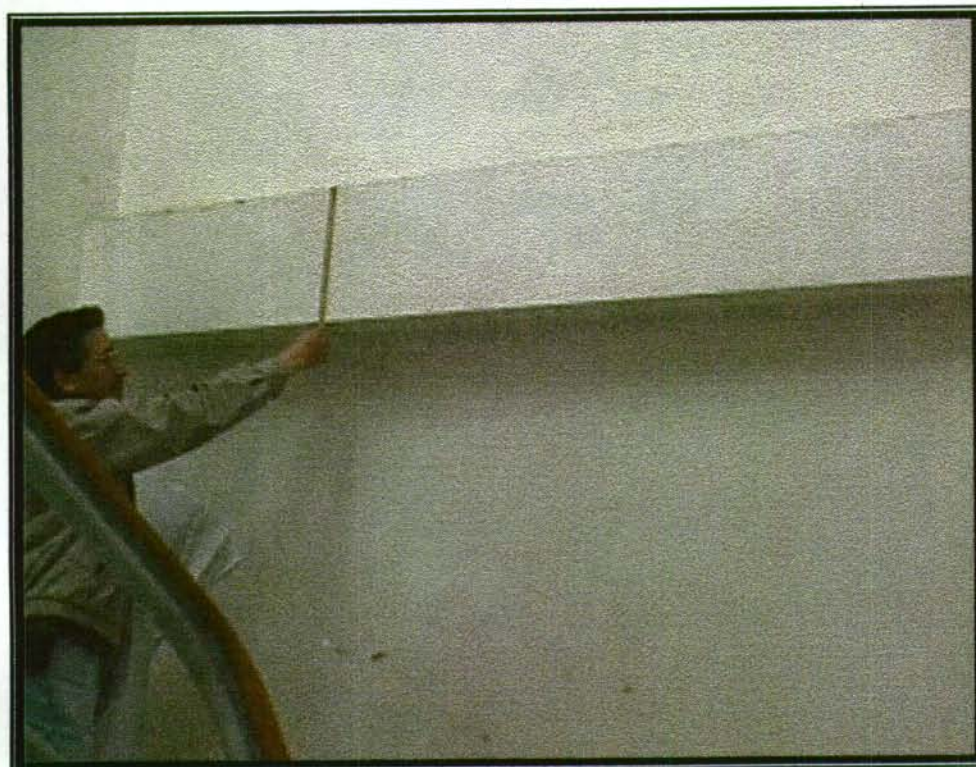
VIGA EN ZONA DE ESCALERA – ZONA DE PORTICOS DE CONCRETO
